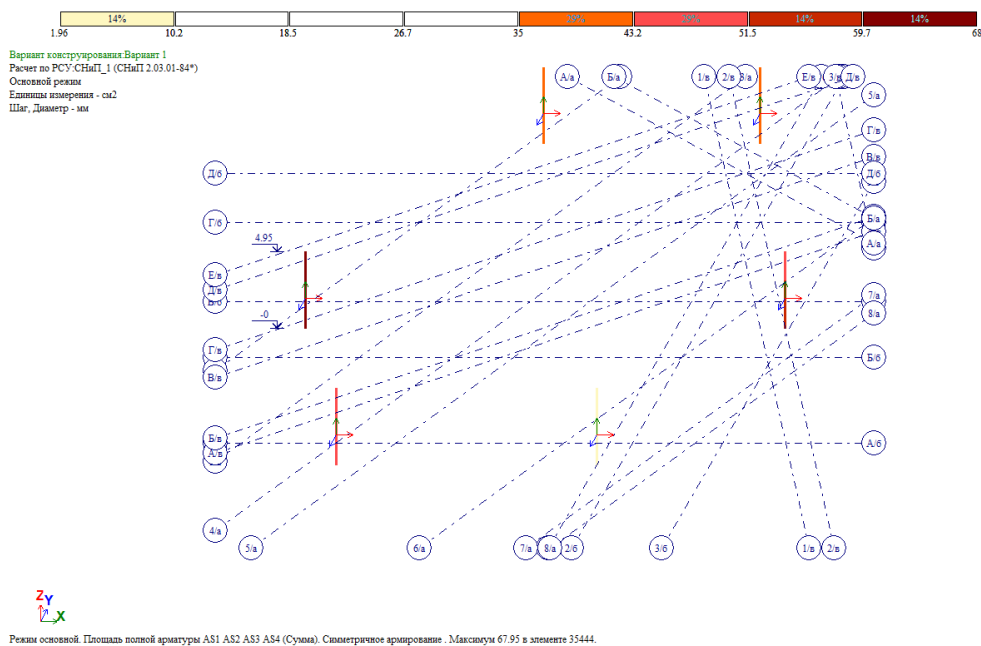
Армирование колонны на отм. 0.000м до отм. 4.95 м (Площадь полной арматуры)
